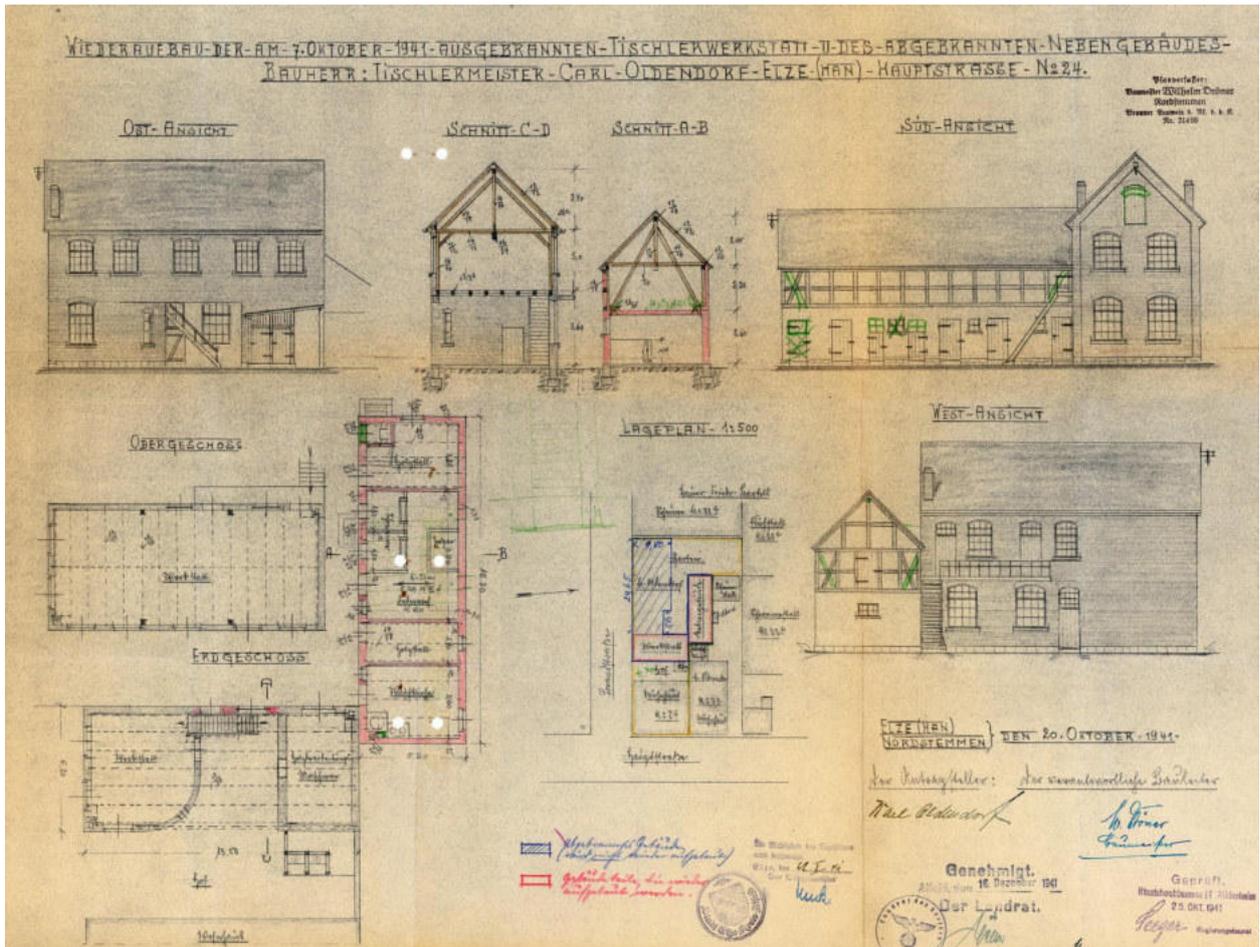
Wiederaufbauplan nach einem Brand für die ehemaligen Hintergebäude auf dem Grundstück Hauptstraße 24 (Tischlerwerkstätten der Firma Oldendorf) mit den heutigen Häusern Brandstraße 2 (Backsteingiebelhaus) und 2a (Flügelbau mit Fachwerkobergeschoss), Oktober 1941.
